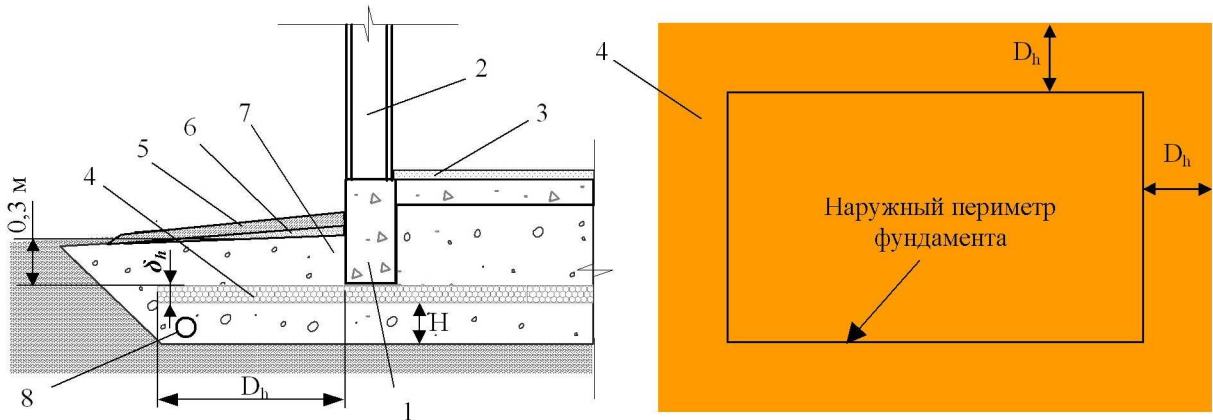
а. Схема укладки и параметры теплоизоляции «Пеноплэкс» в фундаментах неотапливаемых зданий
